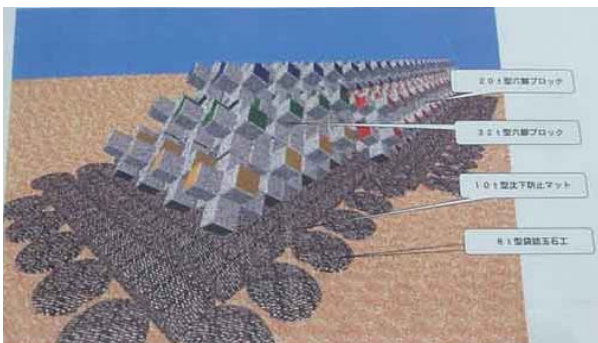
離岸堤の洗掘防止工 (施工イメージ)
